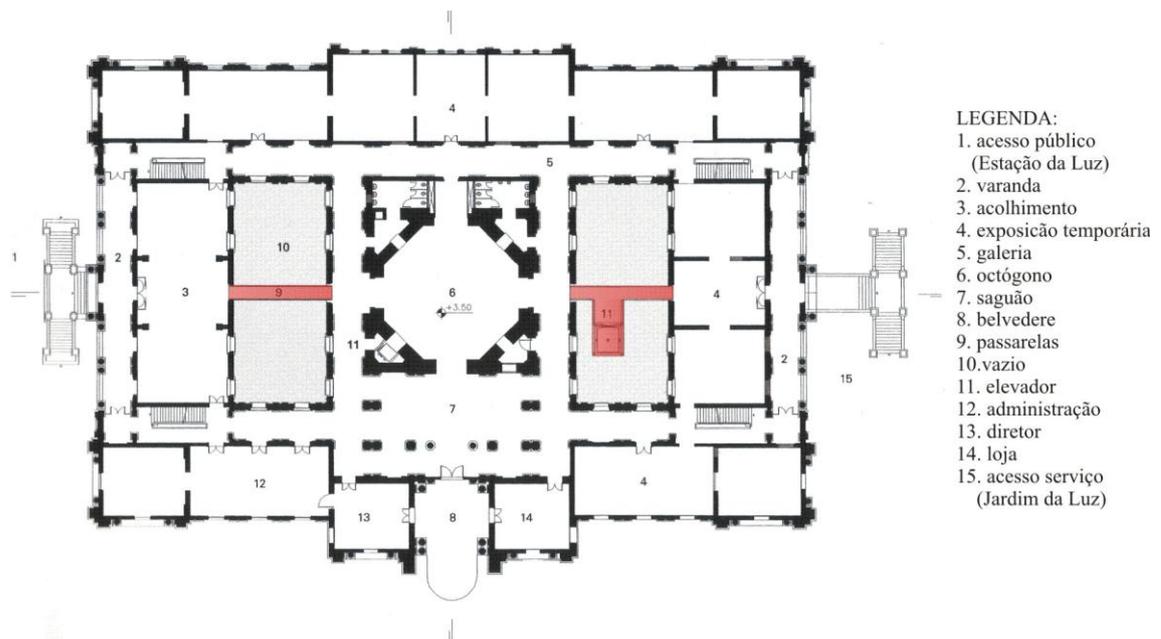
Planta do 1º pavimento da Pinacoteca do Estado de São Paulo.
